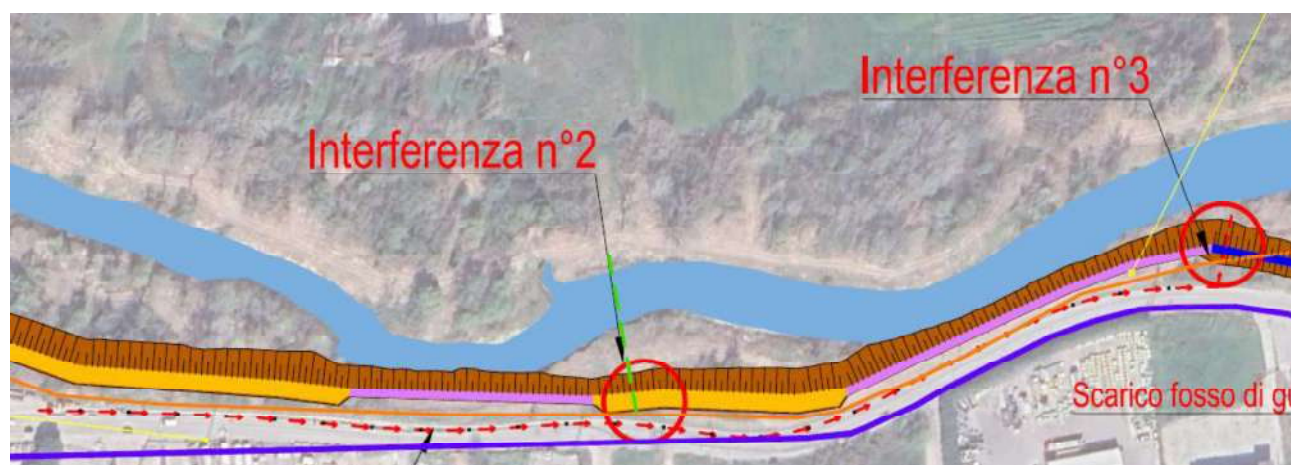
Stralcio planimetrico con ubicazione dell'interferenza tra l'argine di progetto e il sistema di raccolta delle acque di piattaforma stradale
